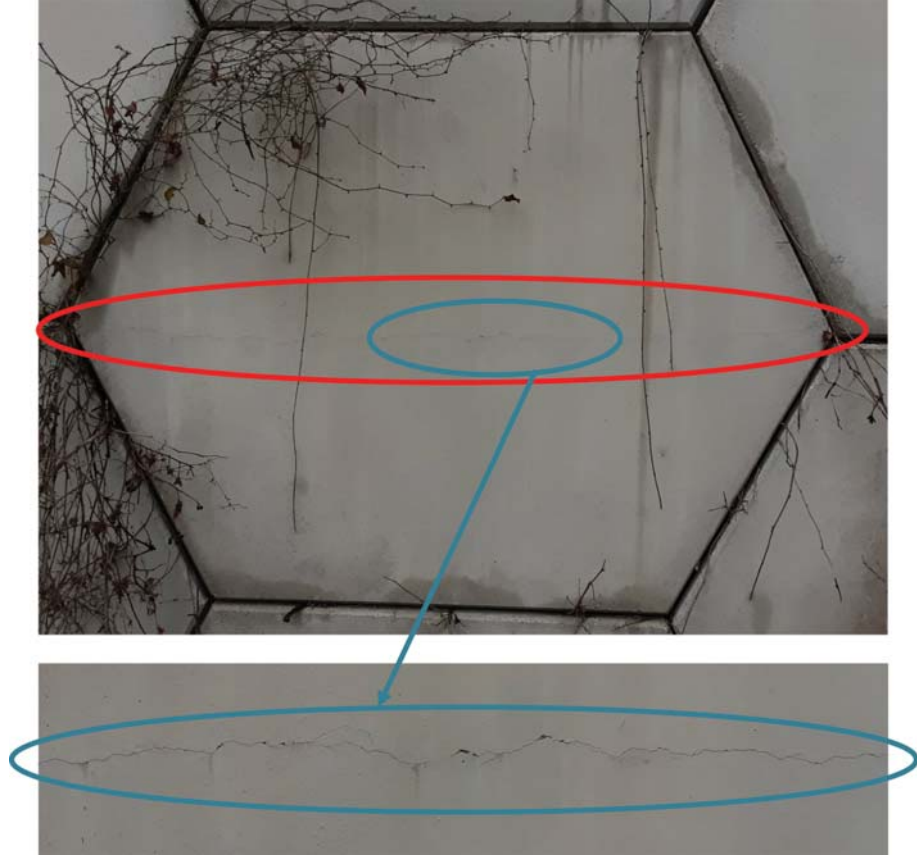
Duvar cephe elemanı olarak kullanılan prekast betonarme altıgen paneller
